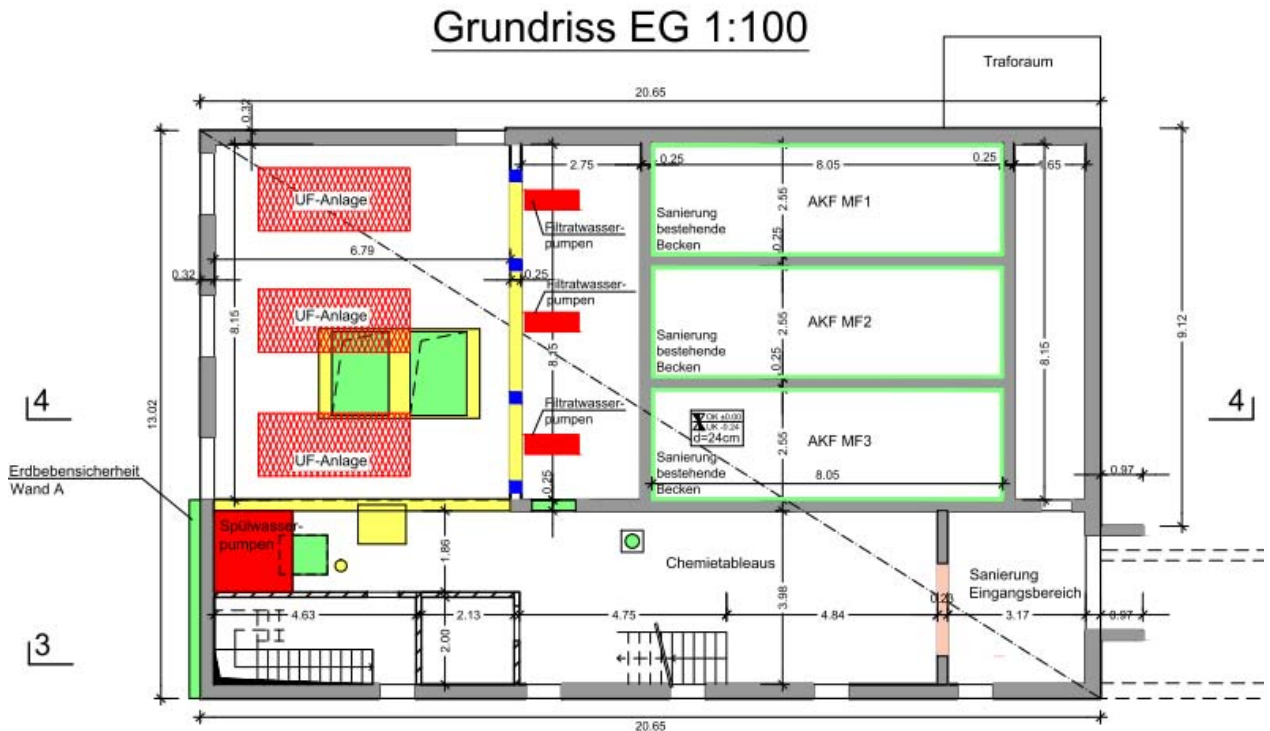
Grundriss EG Layout Raumkonzept
